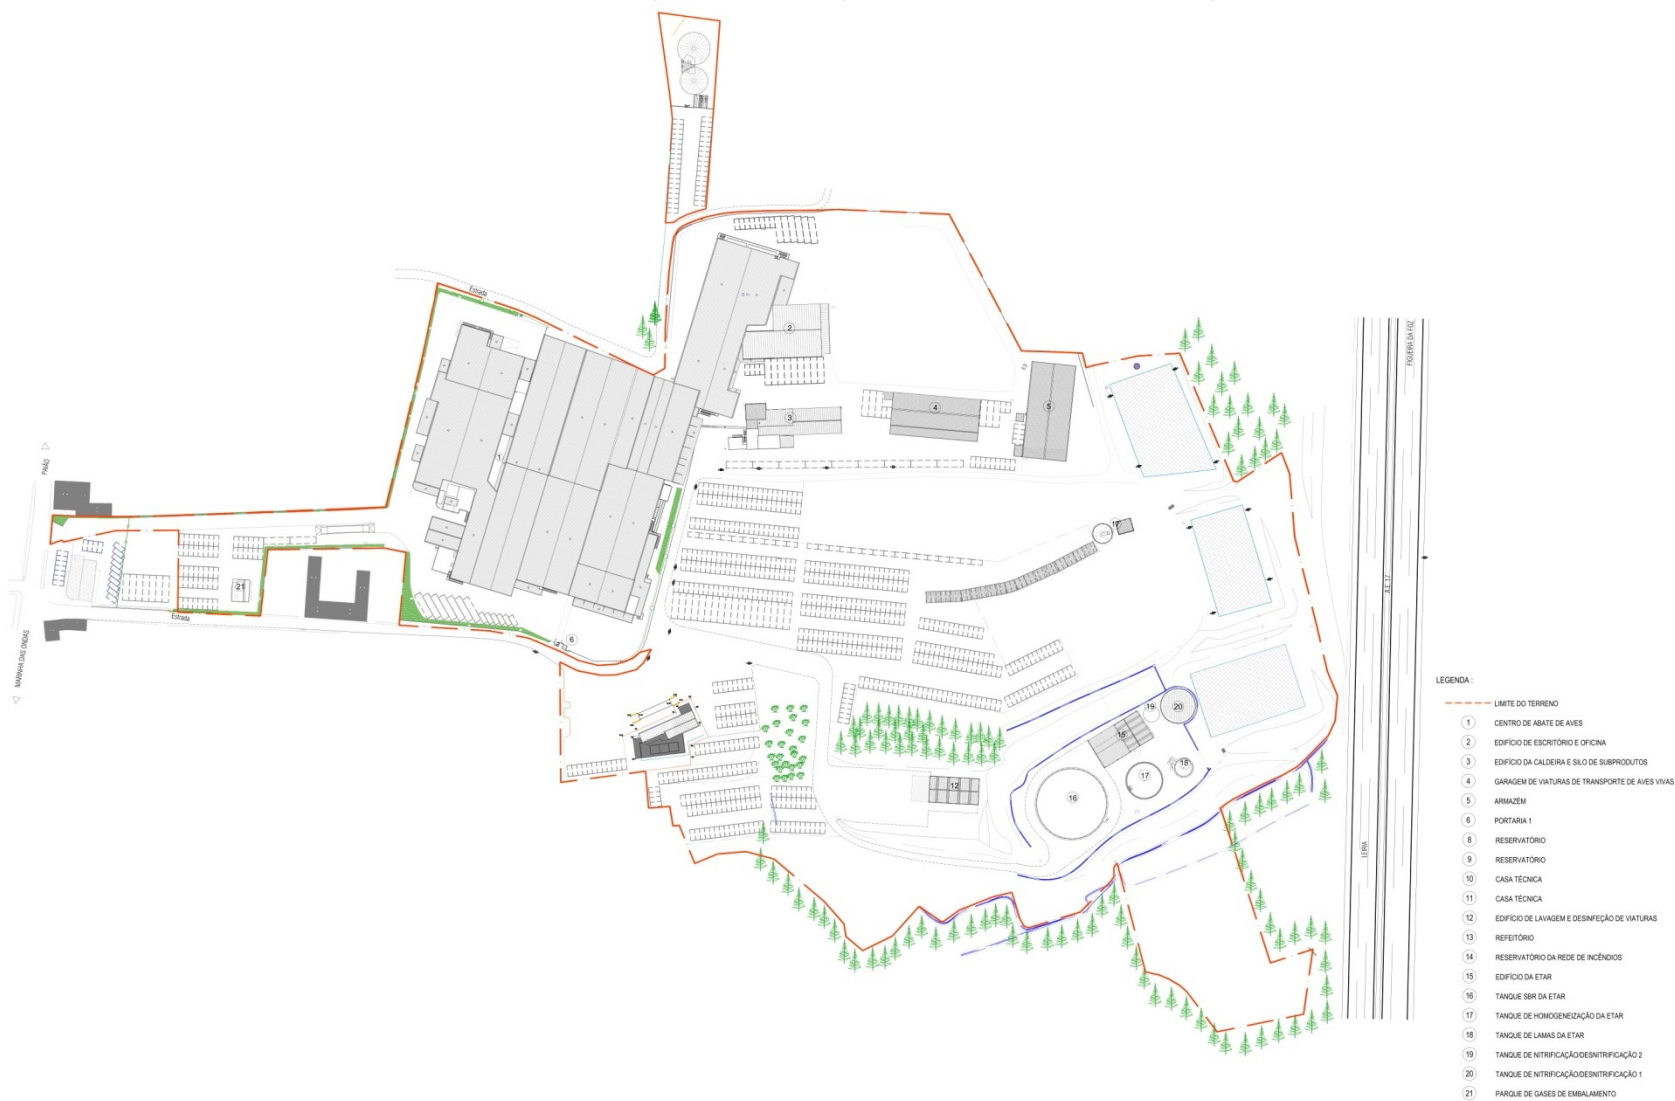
PLANTA DA INSTALAÇÃO APÓS AMPLIAÇÃO DO CAIS DE AVES VIVAS – SITUAÇÃO FUTURA
